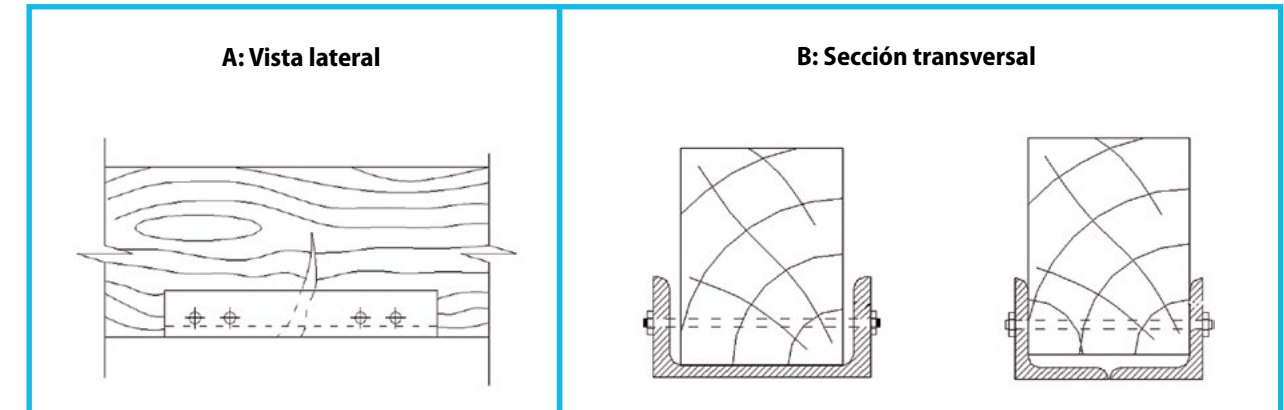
Refuerzo de viga de madera agrietada verticalmente mediante perfil de acero C o L
